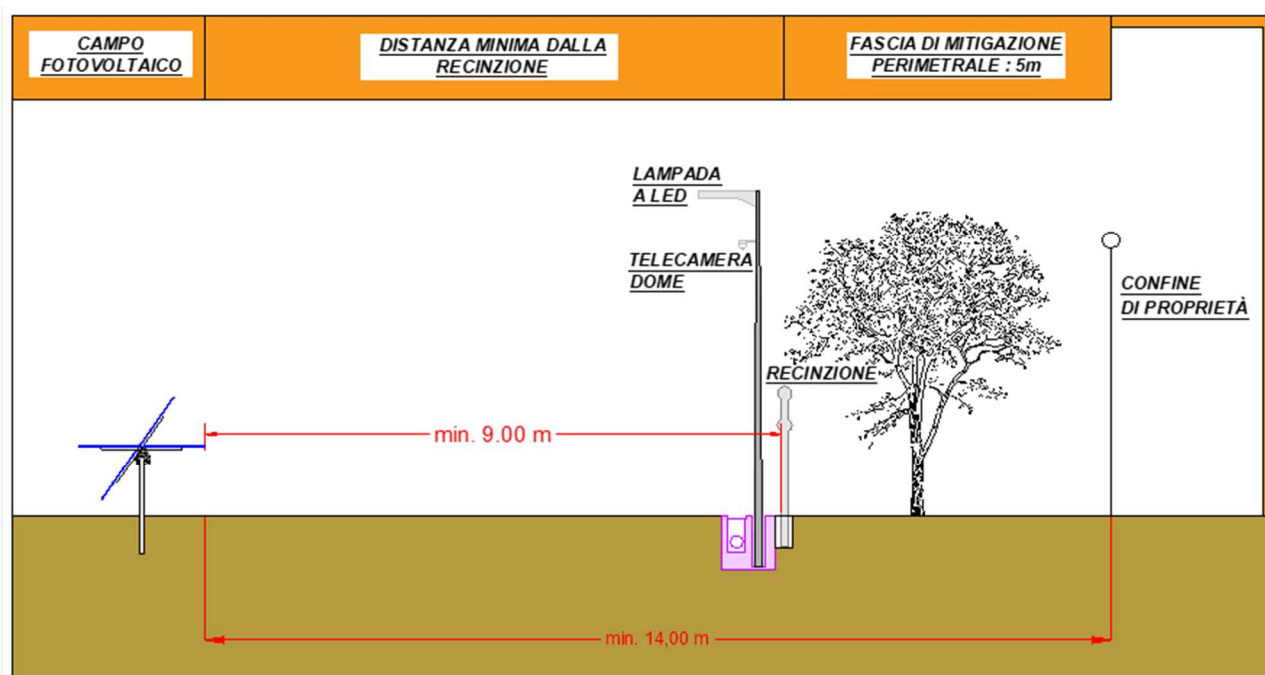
Sezione per piantumazione arbusto con indicazione della fascia perimetrale.
